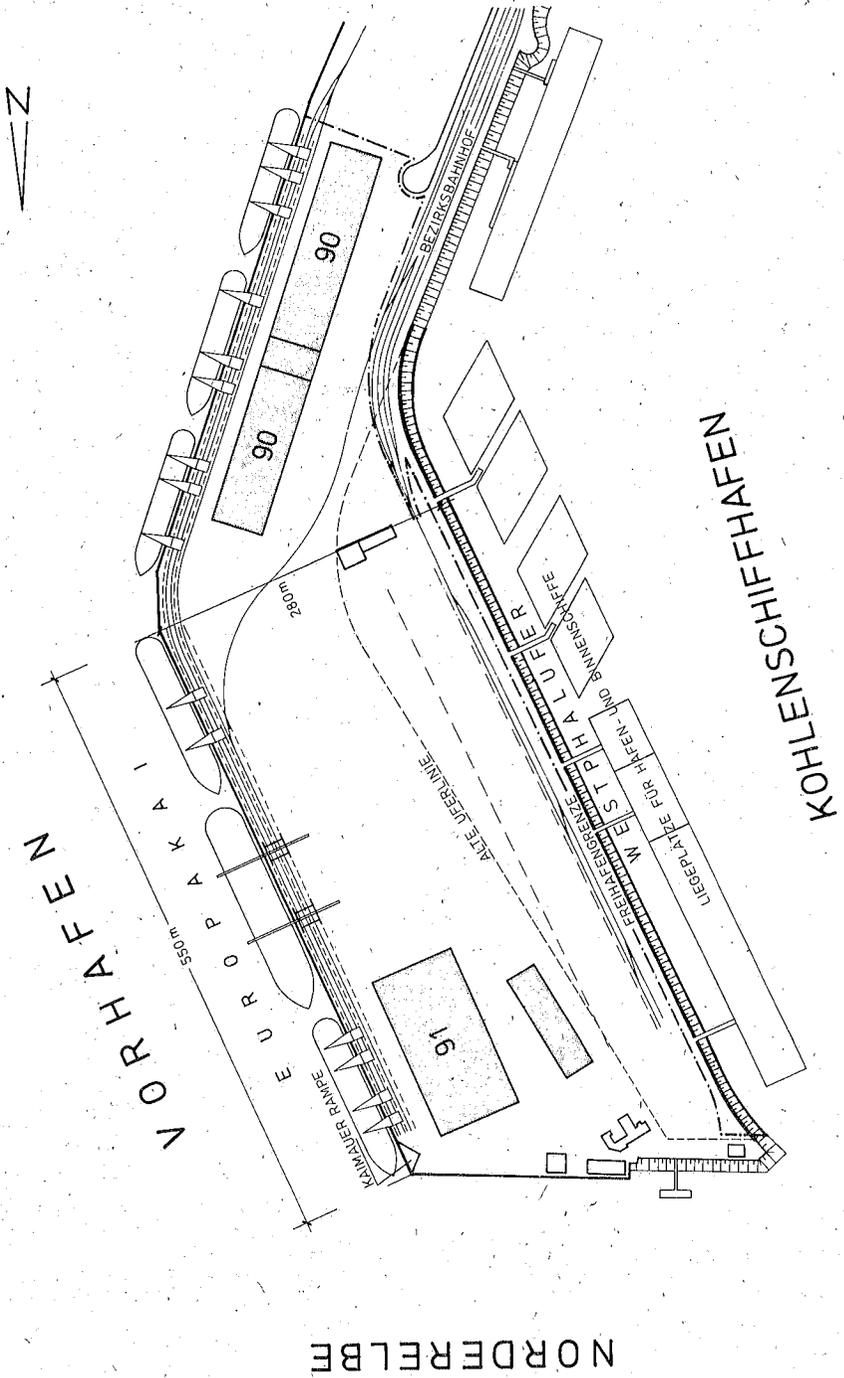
Lageplan des Tollerort-Terminal (Endausbau)
